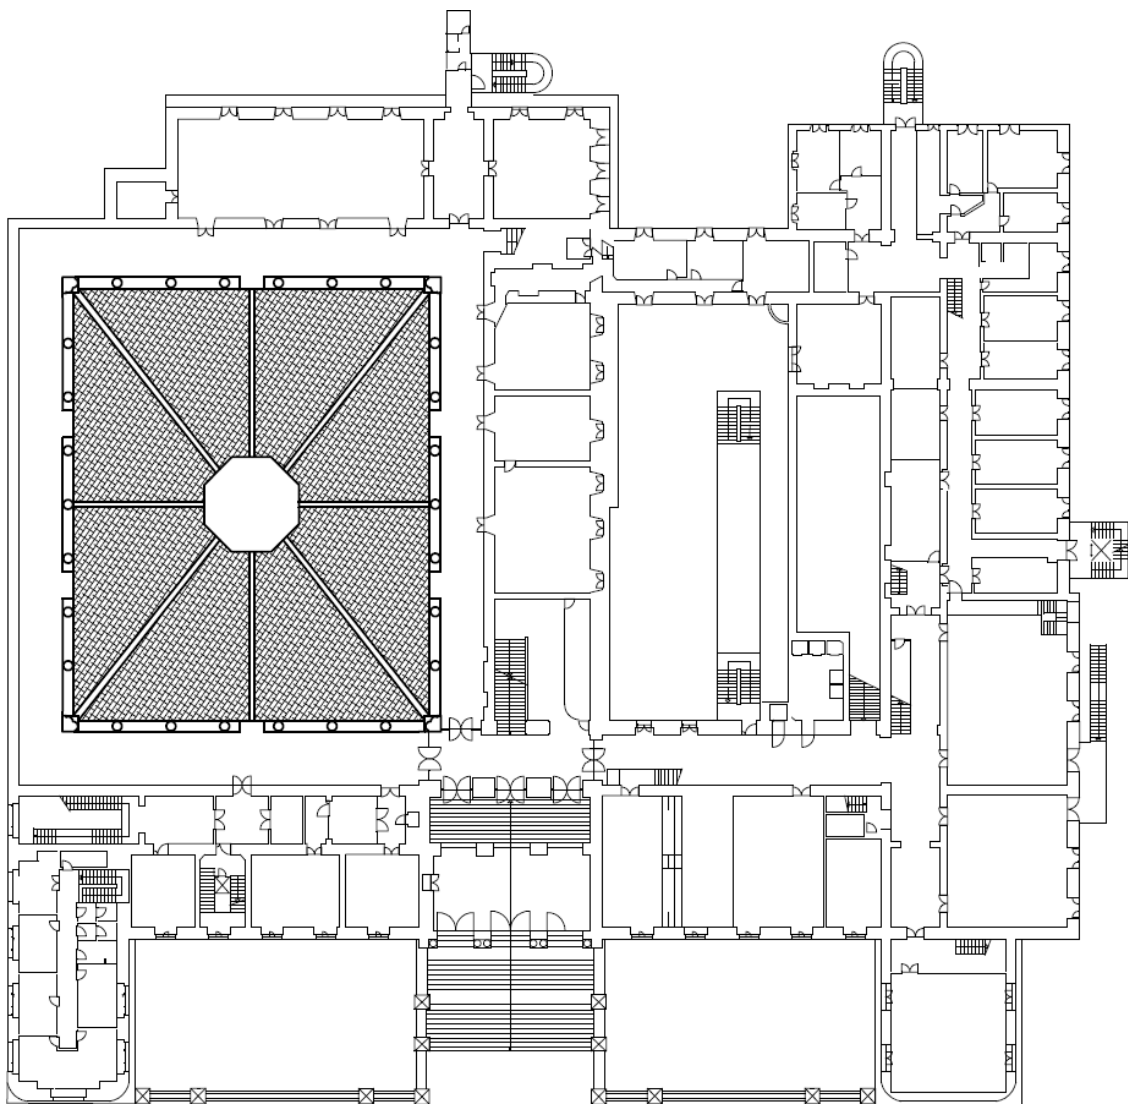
Planimetria generale del complesso di San Pietro in Vincoli con messa in evidenza della planimetria del chiostro rinascimentale.
